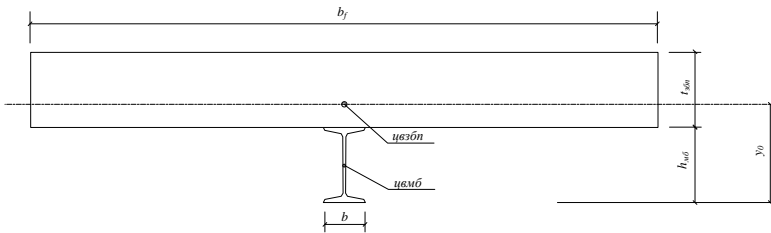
Поперечний переріз сталезалізобетонної комбінованої конструкції
